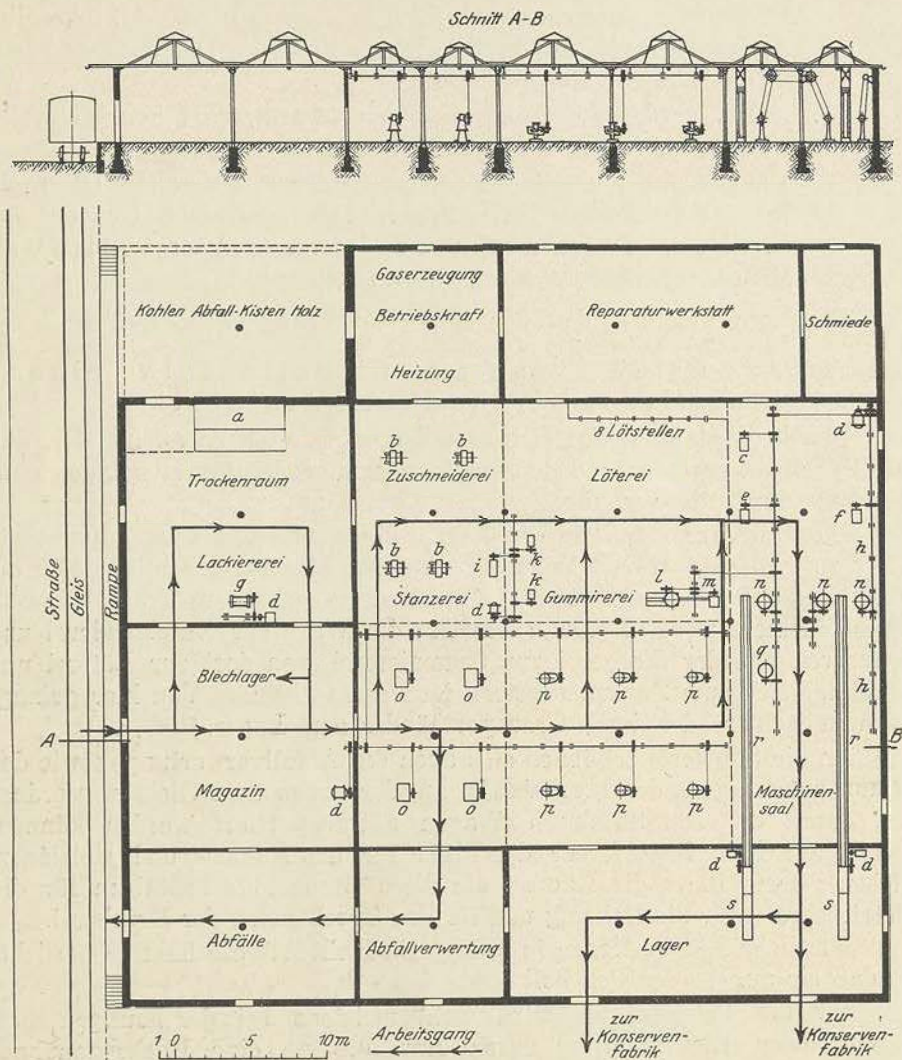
Situationsplan einer Blechemballagenfabrik.
